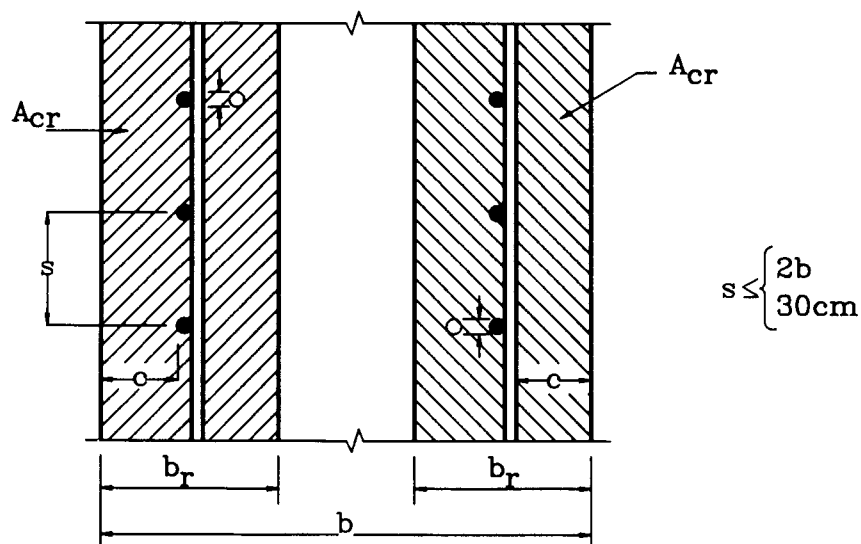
Esquema da Disposição da Armadura de Pele
